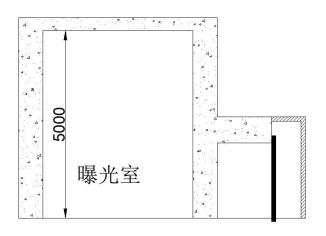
(b) 3#探伤室 1-1 剖面布置示意图
